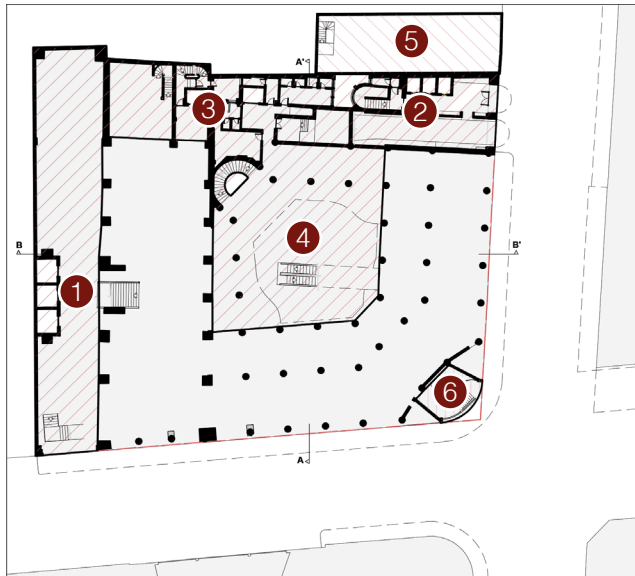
Planta baja demoliciones Edificio Mesbla. (Autoría propia, 2021).
